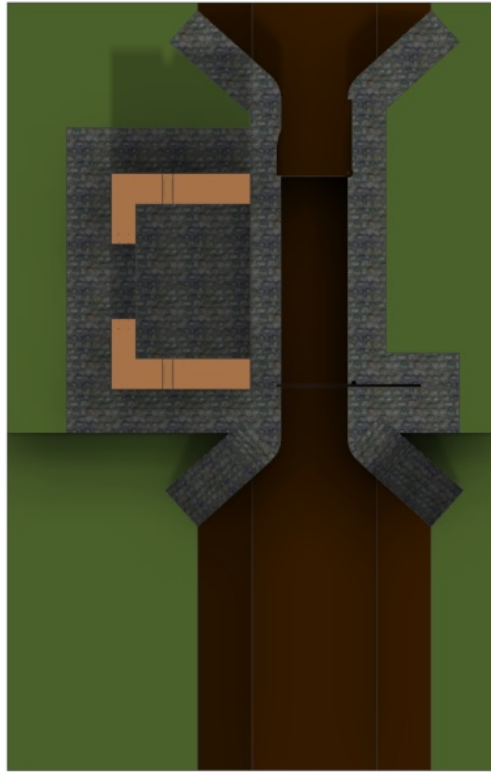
Vista en planta del canal y de la fábrica de ladrillo.
